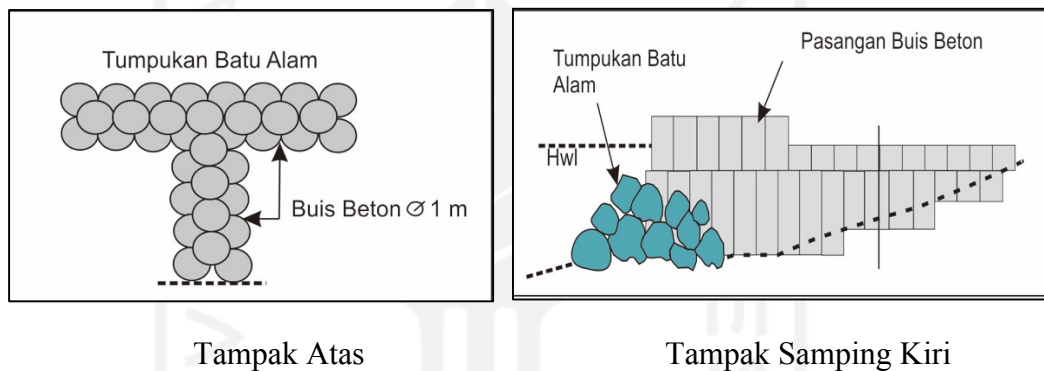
6 Tipikal bentuk bangunan groin pantai
